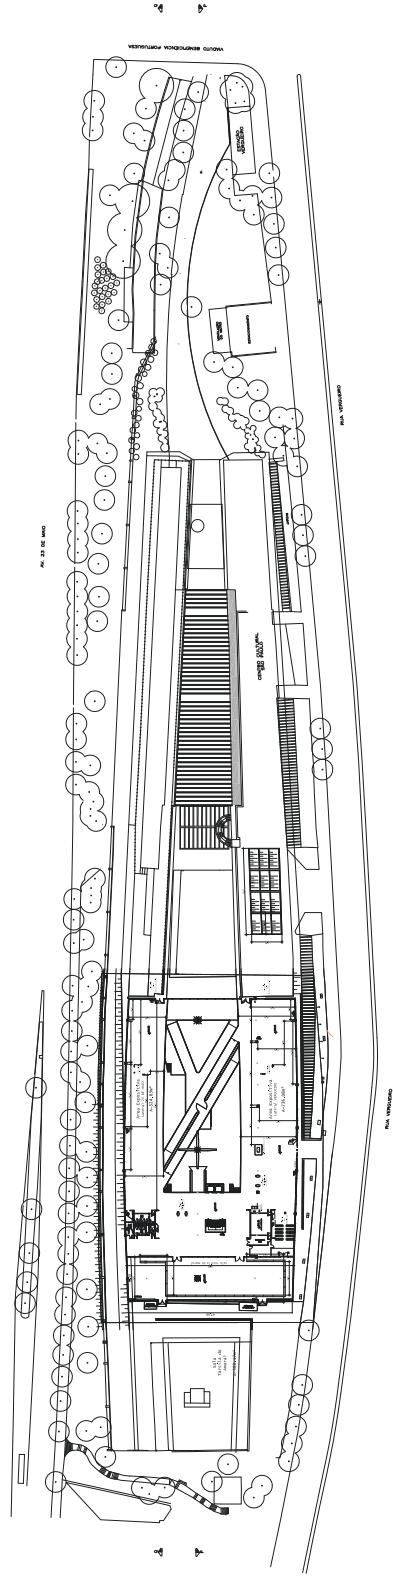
Grundriss 1. Obergeschoss
